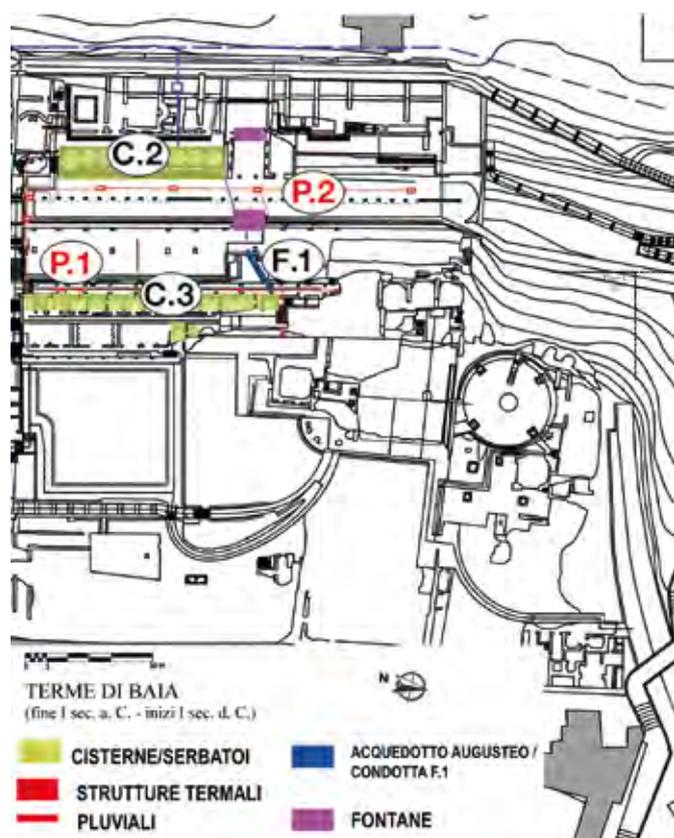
Planimetria con le strutture idrauliche di II fase (rielaborazione di D. De Simone e G. Ferrari).
